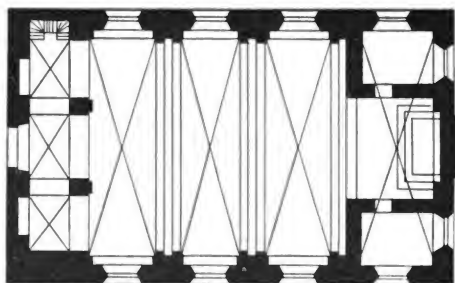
Grundriß der Nikolai-Kirche in Guttstadt.
